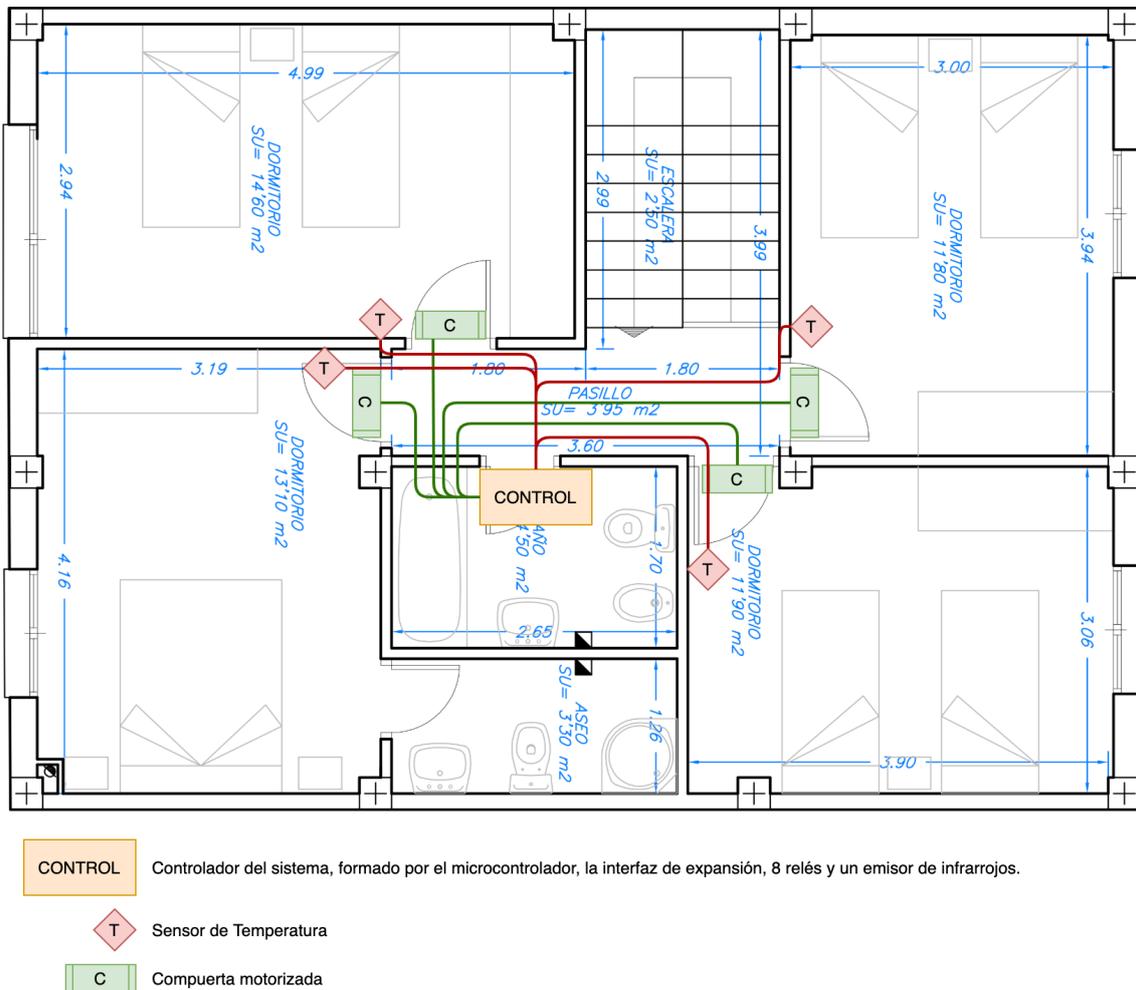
Distribución de componentes sobre el plano de la vivienda
